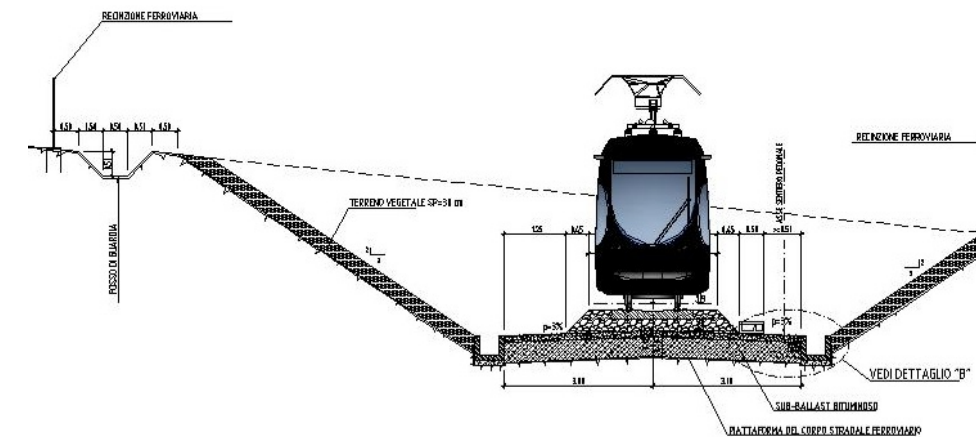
Tracciato ferroviario - Sezione tipo in trincea
